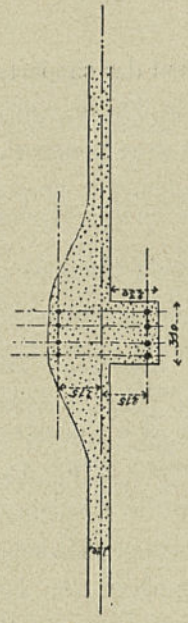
Poutre. - Coupe L. (Pl I Fig 3)
